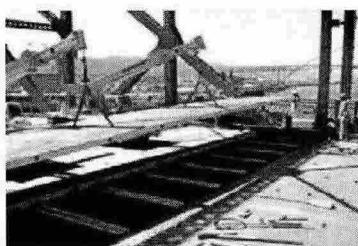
Broadway Bridge 바닥판 시공(미국, 2004)
